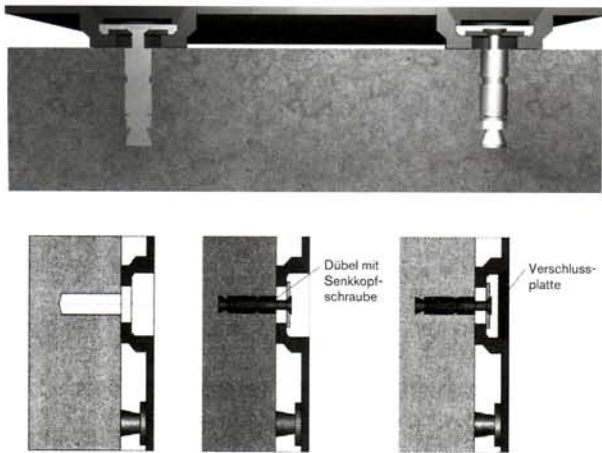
Einbau der Auskleidungsplatten in Betonbauwerken
